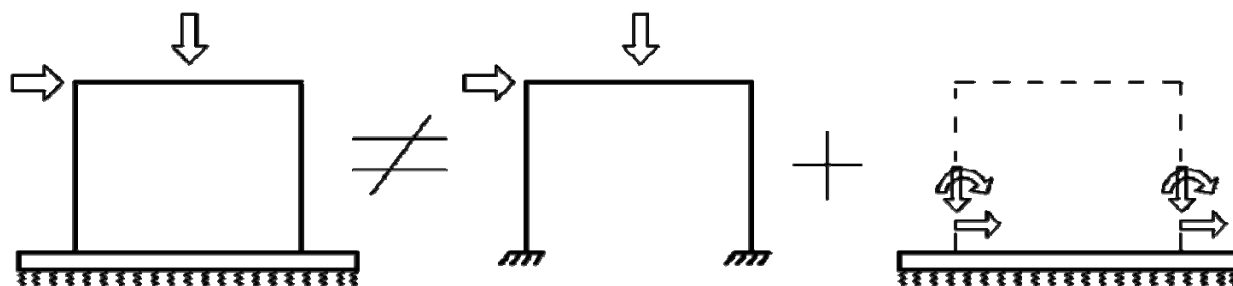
Учет совместной работы «надземное строение – фундаментная плита – грунтовое основание»
